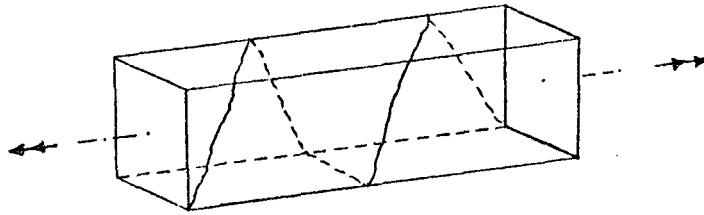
Spiralförmige Risse bei unbewehrtem Beton bei reiner Torsion
